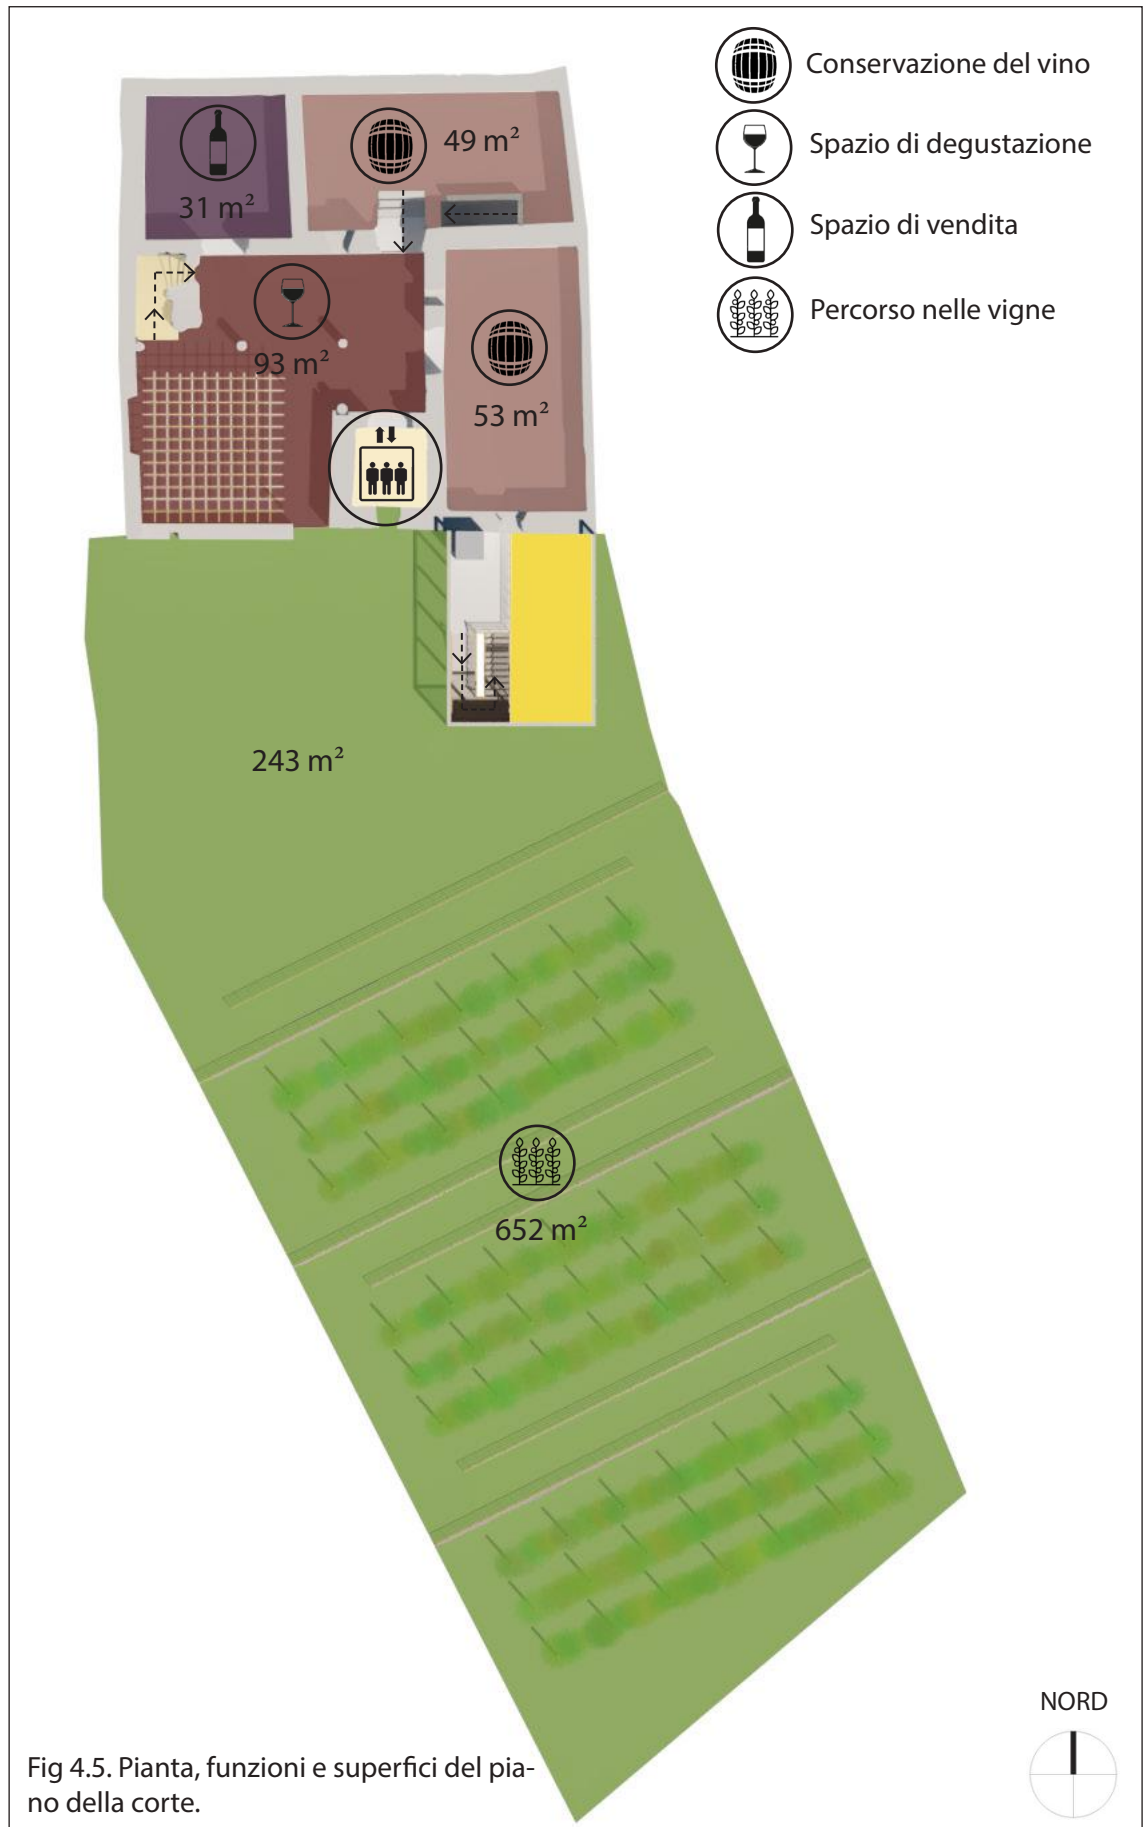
Pianta, funzioni e superfici del piano della corte.
